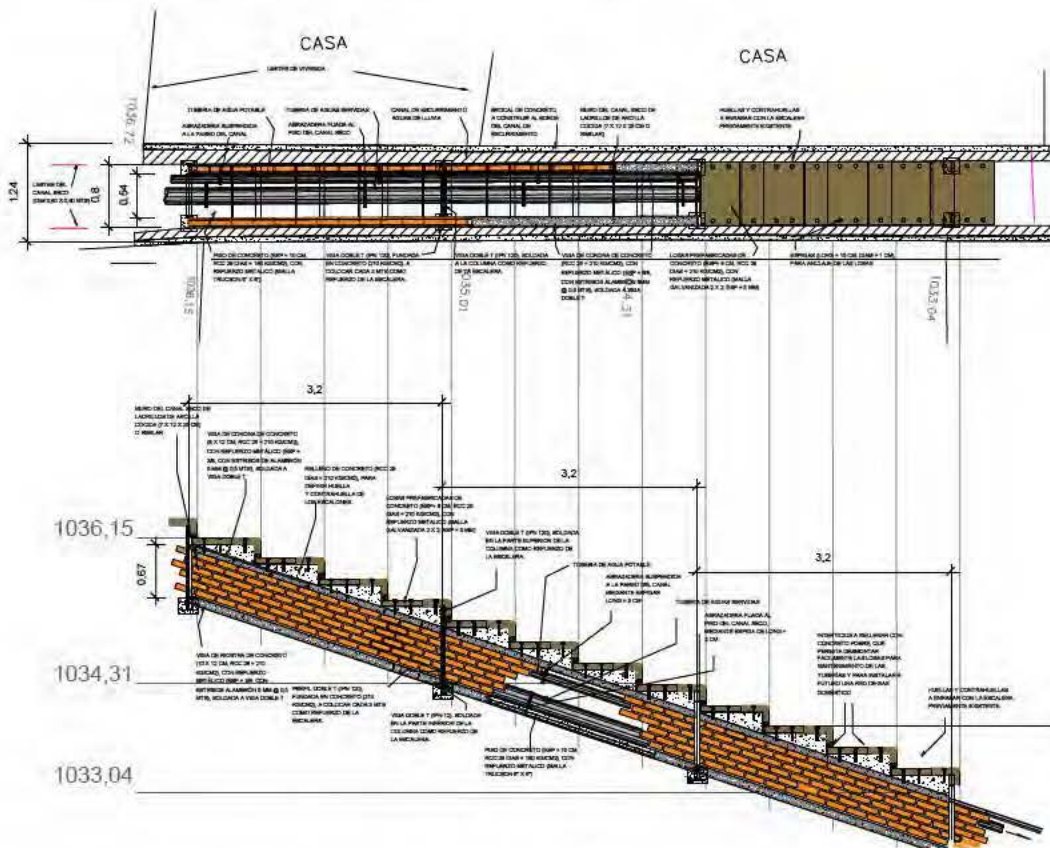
Vista en planta y en corte del ducto de servicios del proyecto de acueducto y alcantarillado de la Palomera
